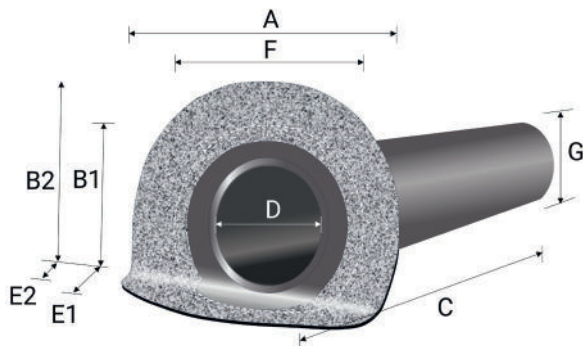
Flansch mit verpresster Manschette (nur DN 70 / 100 für Bitumenschweißbahn u. EPDM)
